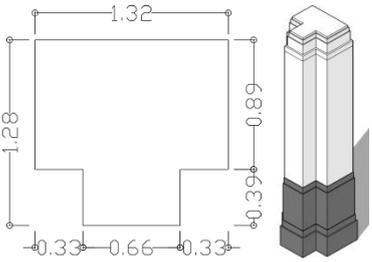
82 Denah Peletakan Kolom Pada Bangunan
